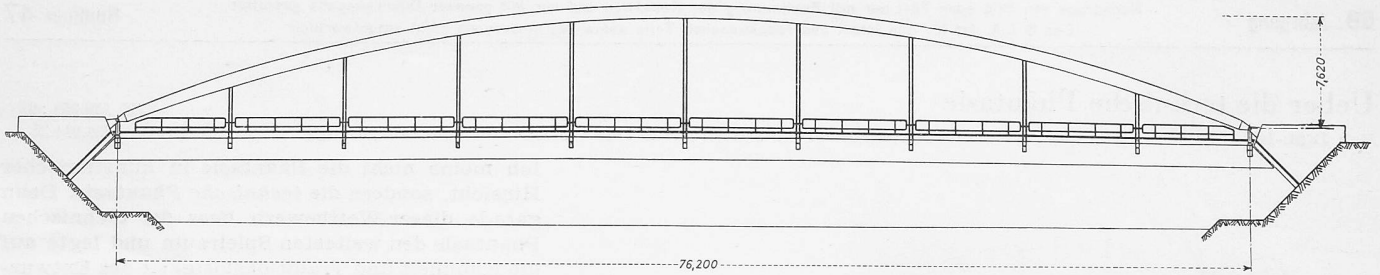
Brücken-Aufriss 1:500 zum Wettbewerbsentwurf
